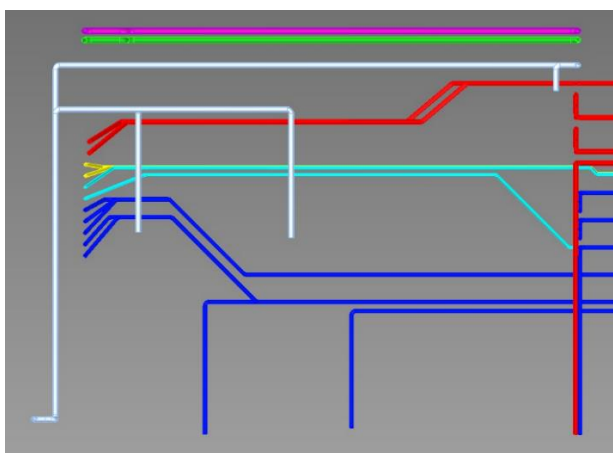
Vista tubazioni addossate alla parete ovest (Solid Edge)
